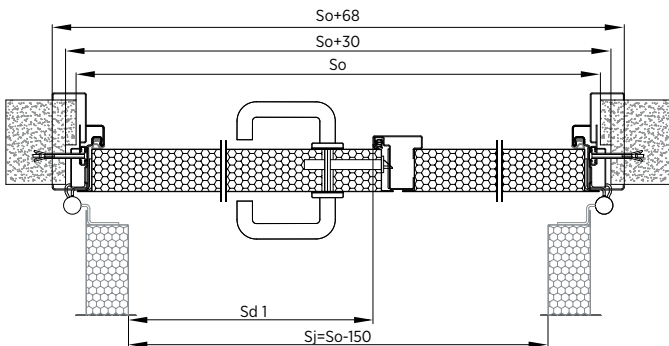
Pose au mur - bloc-porte à deux vantaux - bâti angulaire à rupture de pont thermique - coupe horizontale
